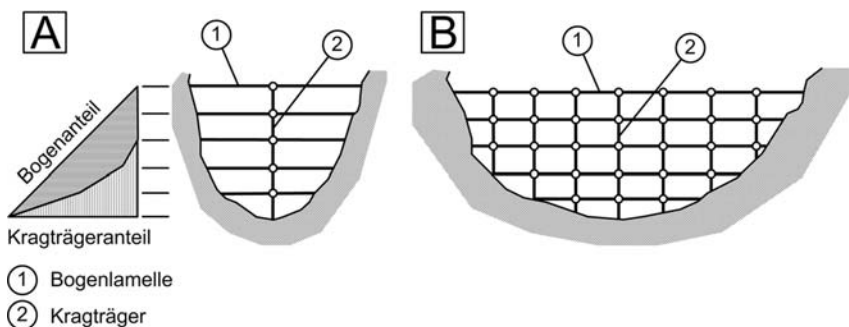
Trägerrostformen: (A) einschnittiger Trägerrost; (B) mehrschnittiger Trägerrost
